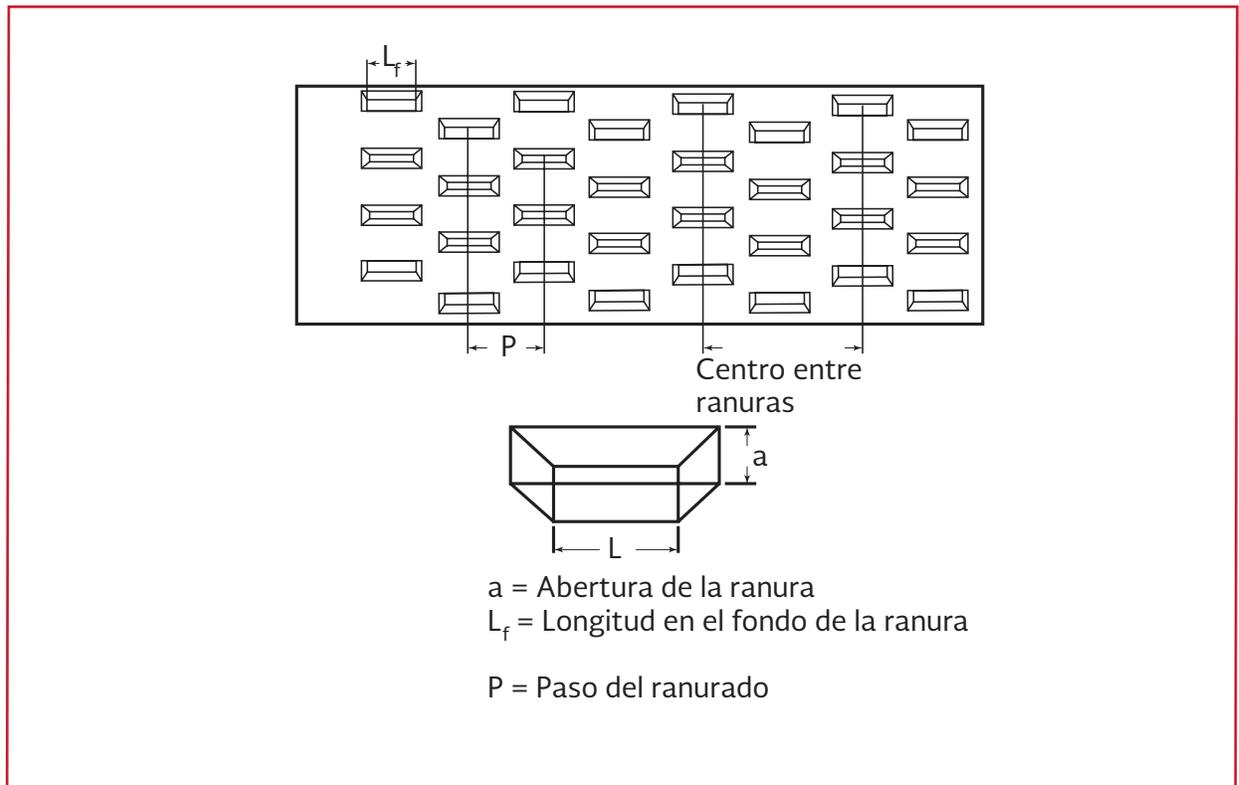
Ademe con ranuras longitudinales rectas
